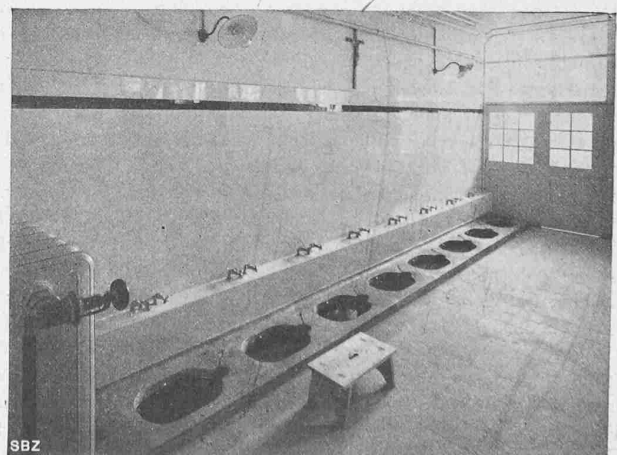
Fussbad-Becken (vergl. Grundriss Seite 285).
